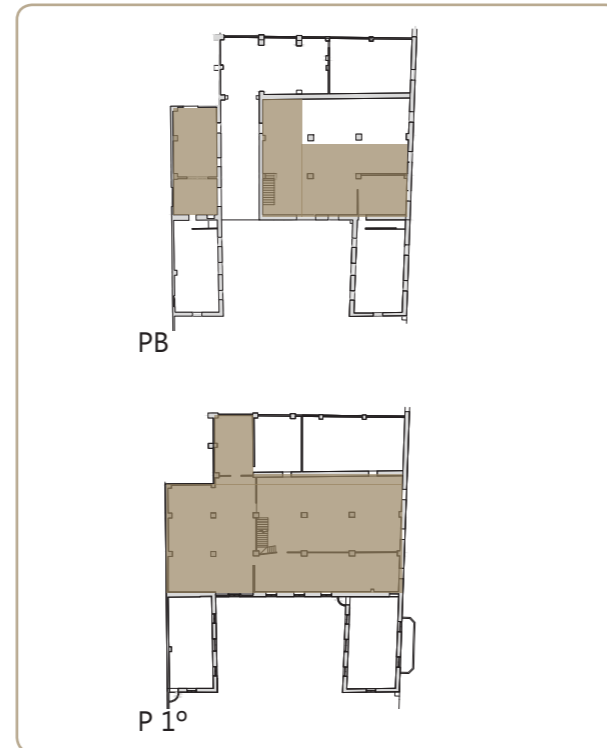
(Izquierda) Esquemas localización pavimento barro cocido.
